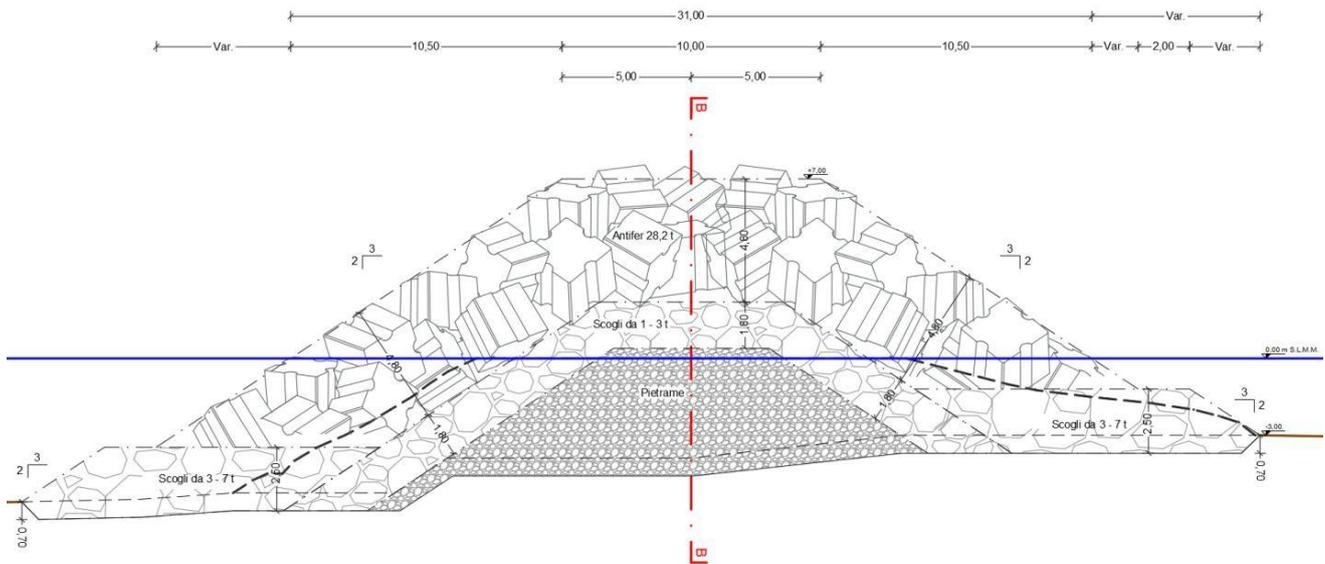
Prolungamento della diga foranea: sezione tipo di progetto
